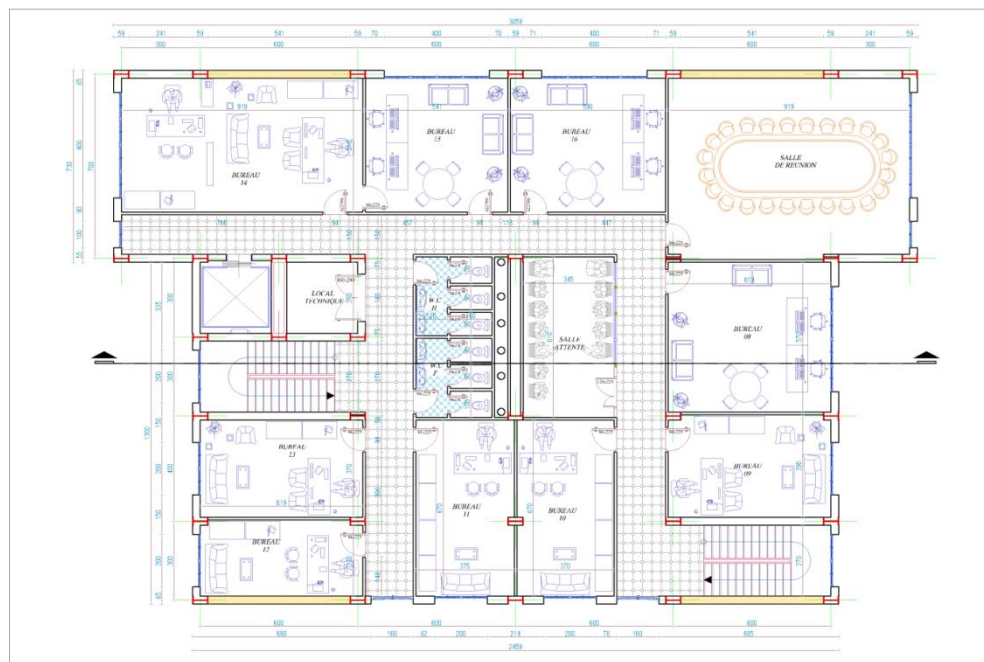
Vue en plan d'étage courant (1er au 7eme) 2chelle 1/50.
